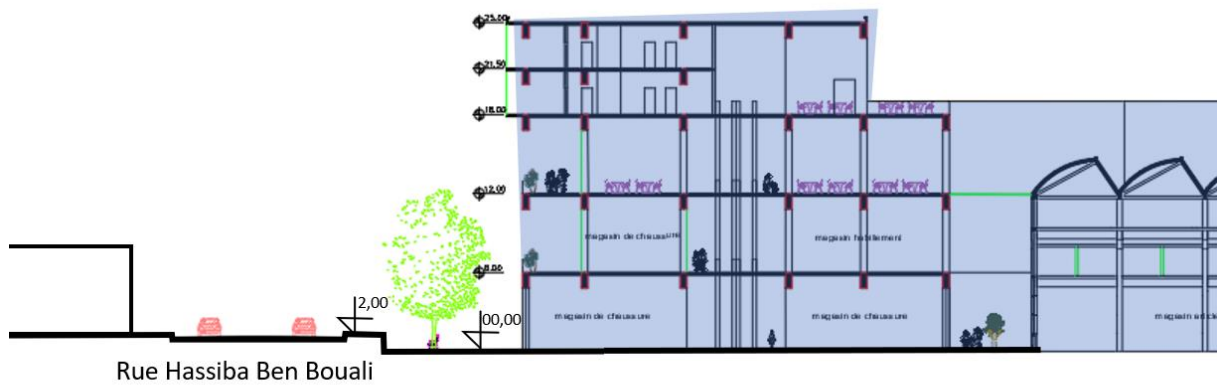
Coupe schématique d'implantation. (Source : auteur)
